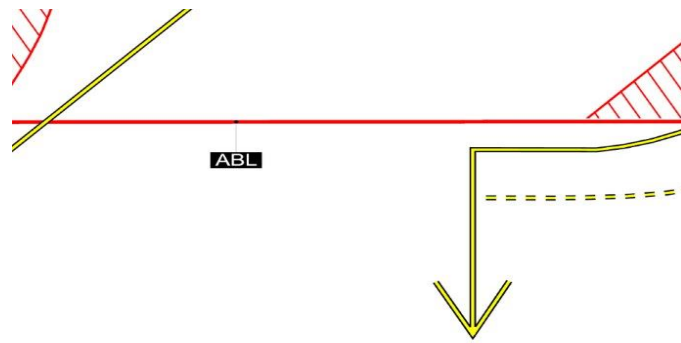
Stralcio segnaletica di separazione sul Piazzale tra Traffico Aereo e Veicolare
